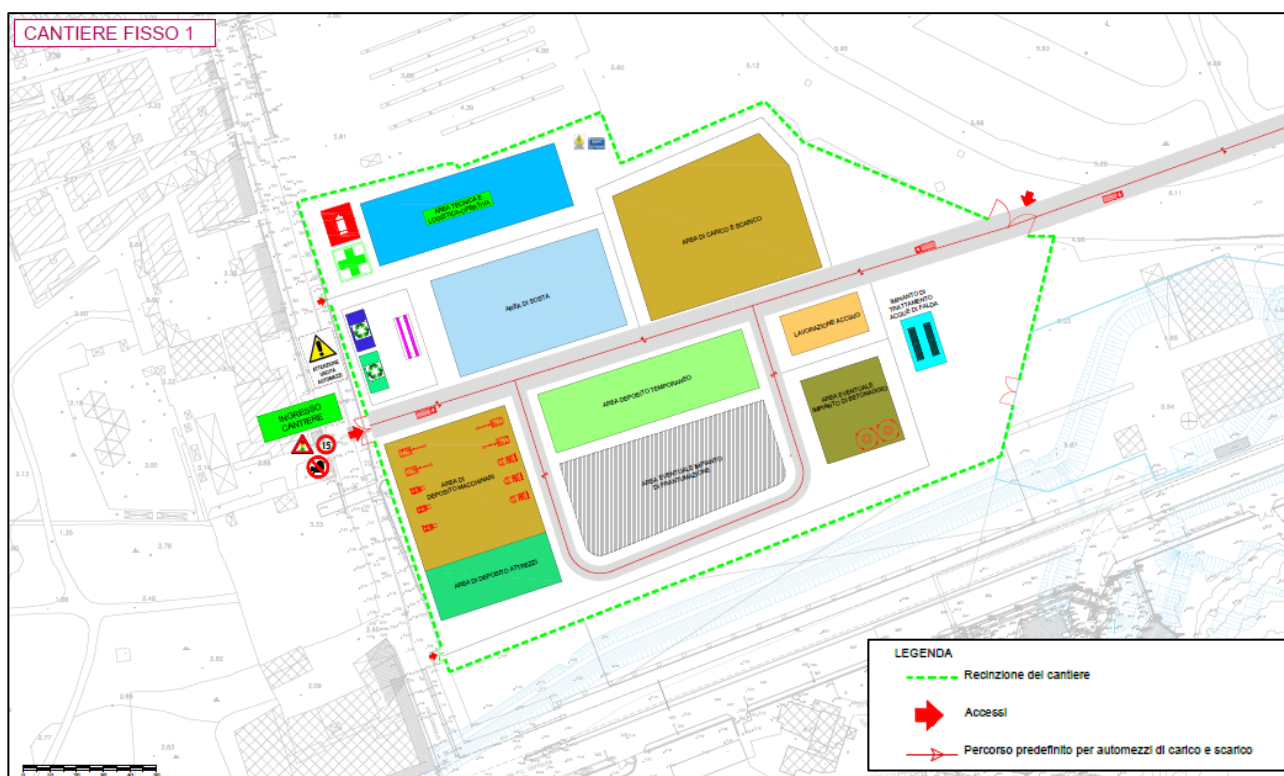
Planimetria Cantiere Fisso 1 (Elaborato: 2021INV-D-PS-PL.10.01.01.01)
